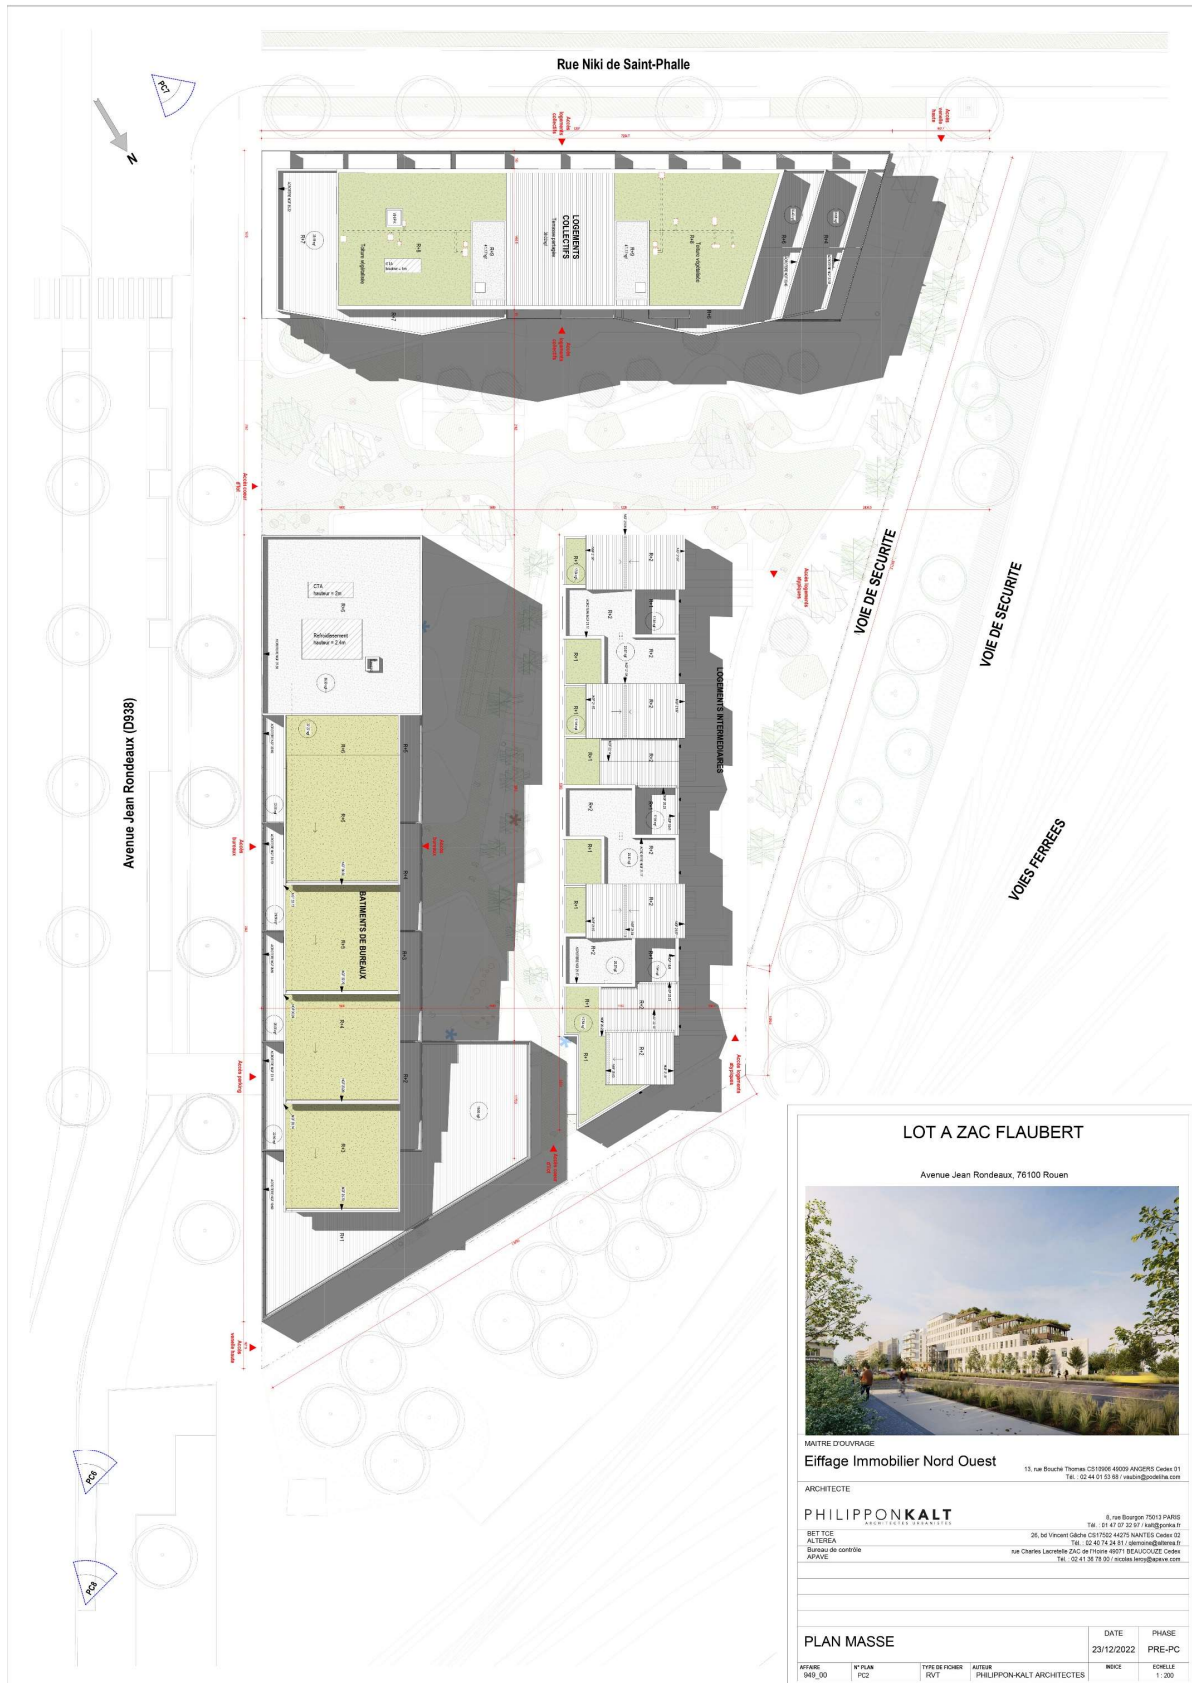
Plan de masse du projet (source : EIFFAGE IMMOBILIER)
